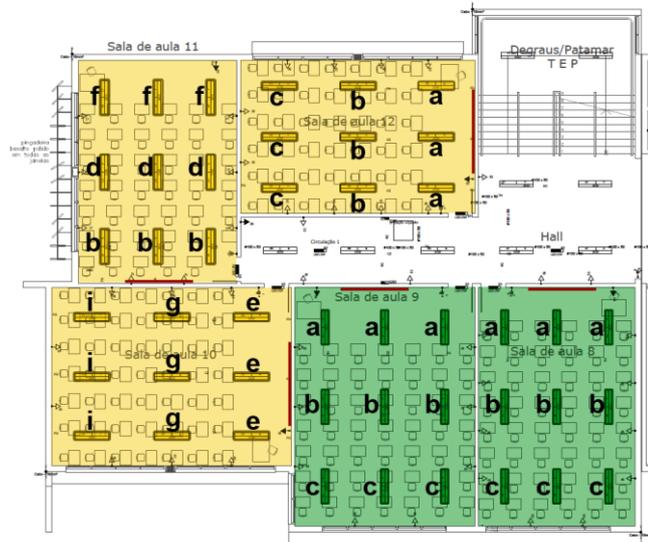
Iluminação das salas de aula no 3º pavimento do Projeto 4.
